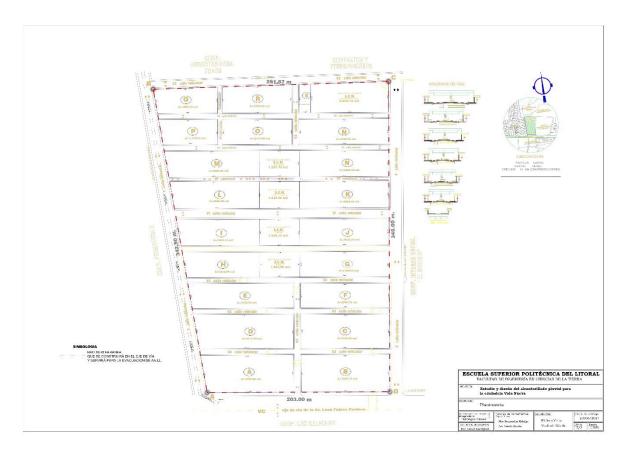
Planimetría 2. Fuente: Elaboración propia
